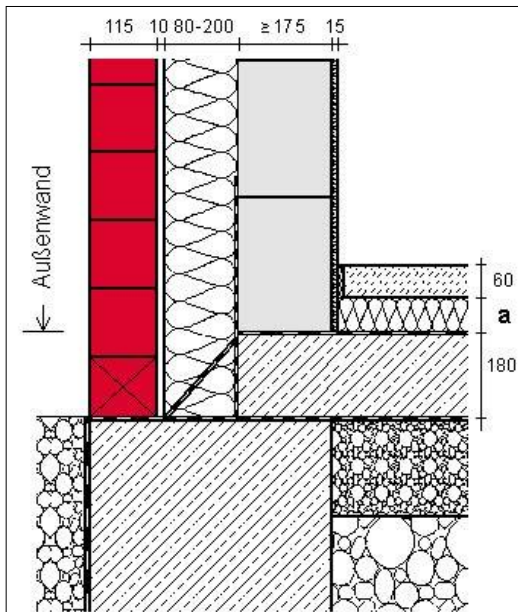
Detall constructiu d'una secció de façana amb Klinker.
